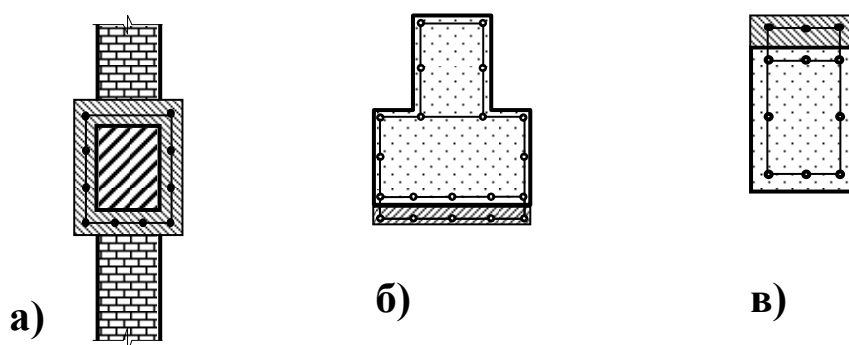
Підсилення залізобетонних балок методами збільшення перетину:
